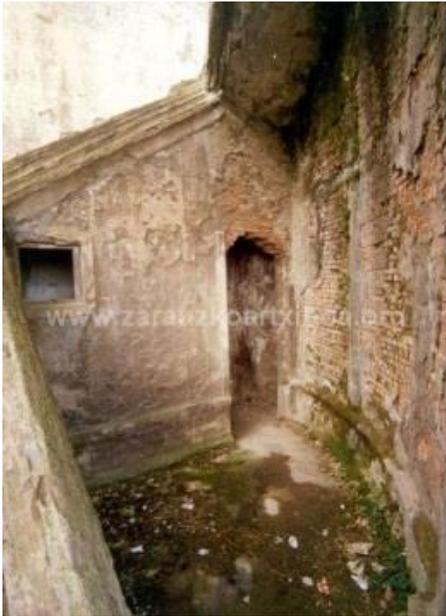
Puerta bajo la escalera de subida al 2º piso, torreón de Vista Alegre
